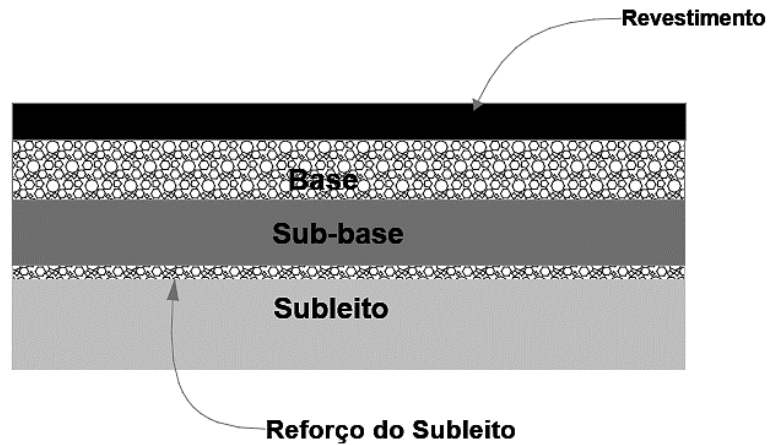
Estrutura do pavimento flexível (Fonte: autor, 2023)
